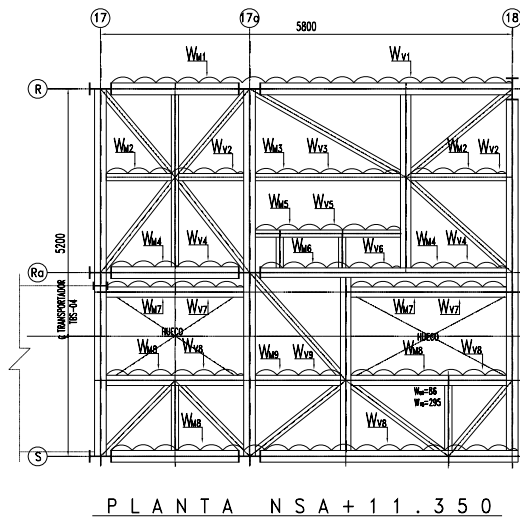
Plantas de Operación TT-5, con cargas distribuidas y estructuración
